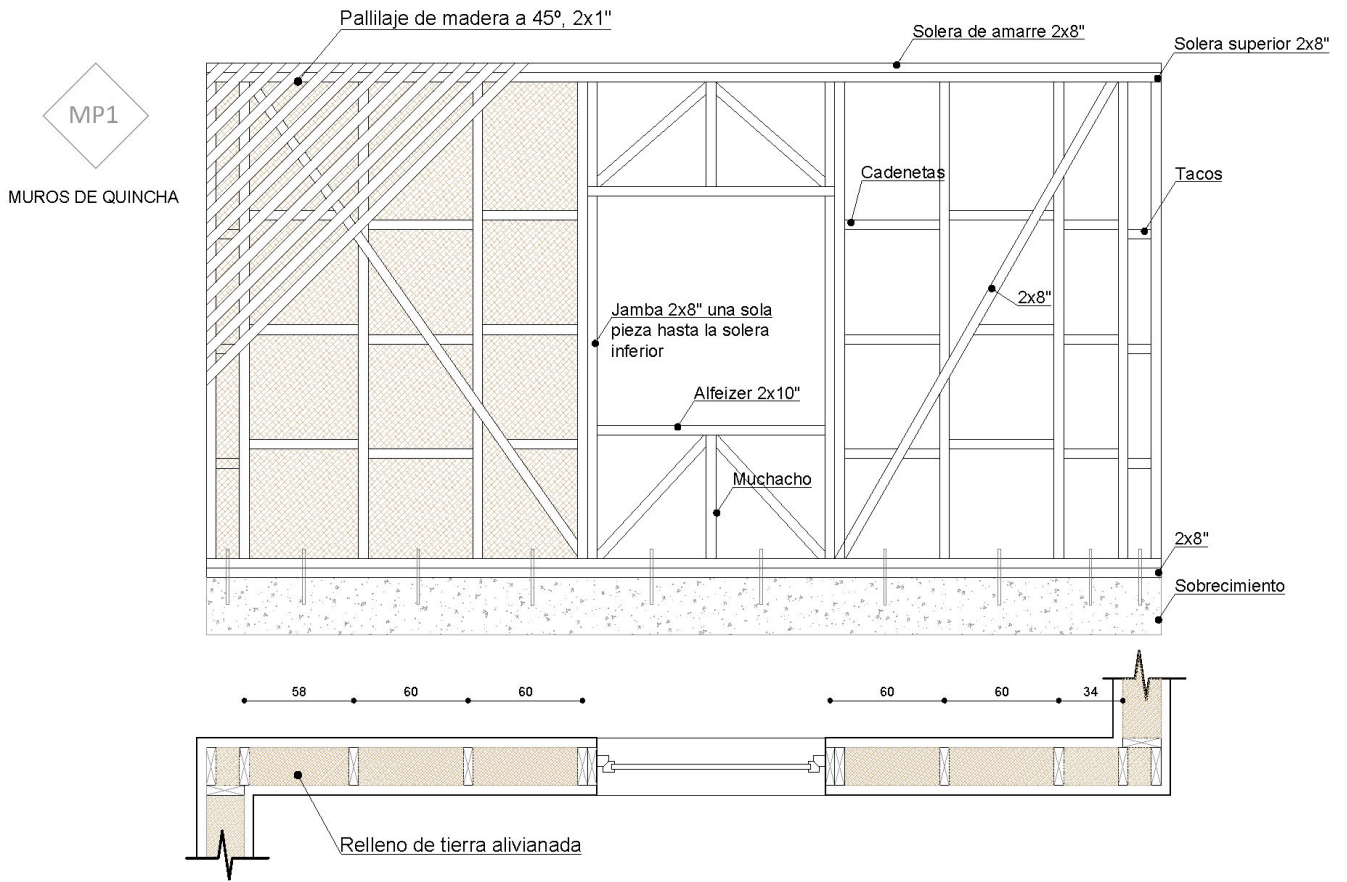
Detalle constructivo tipo de la estructura en quinchal de proyecto. Elaboración propia.
